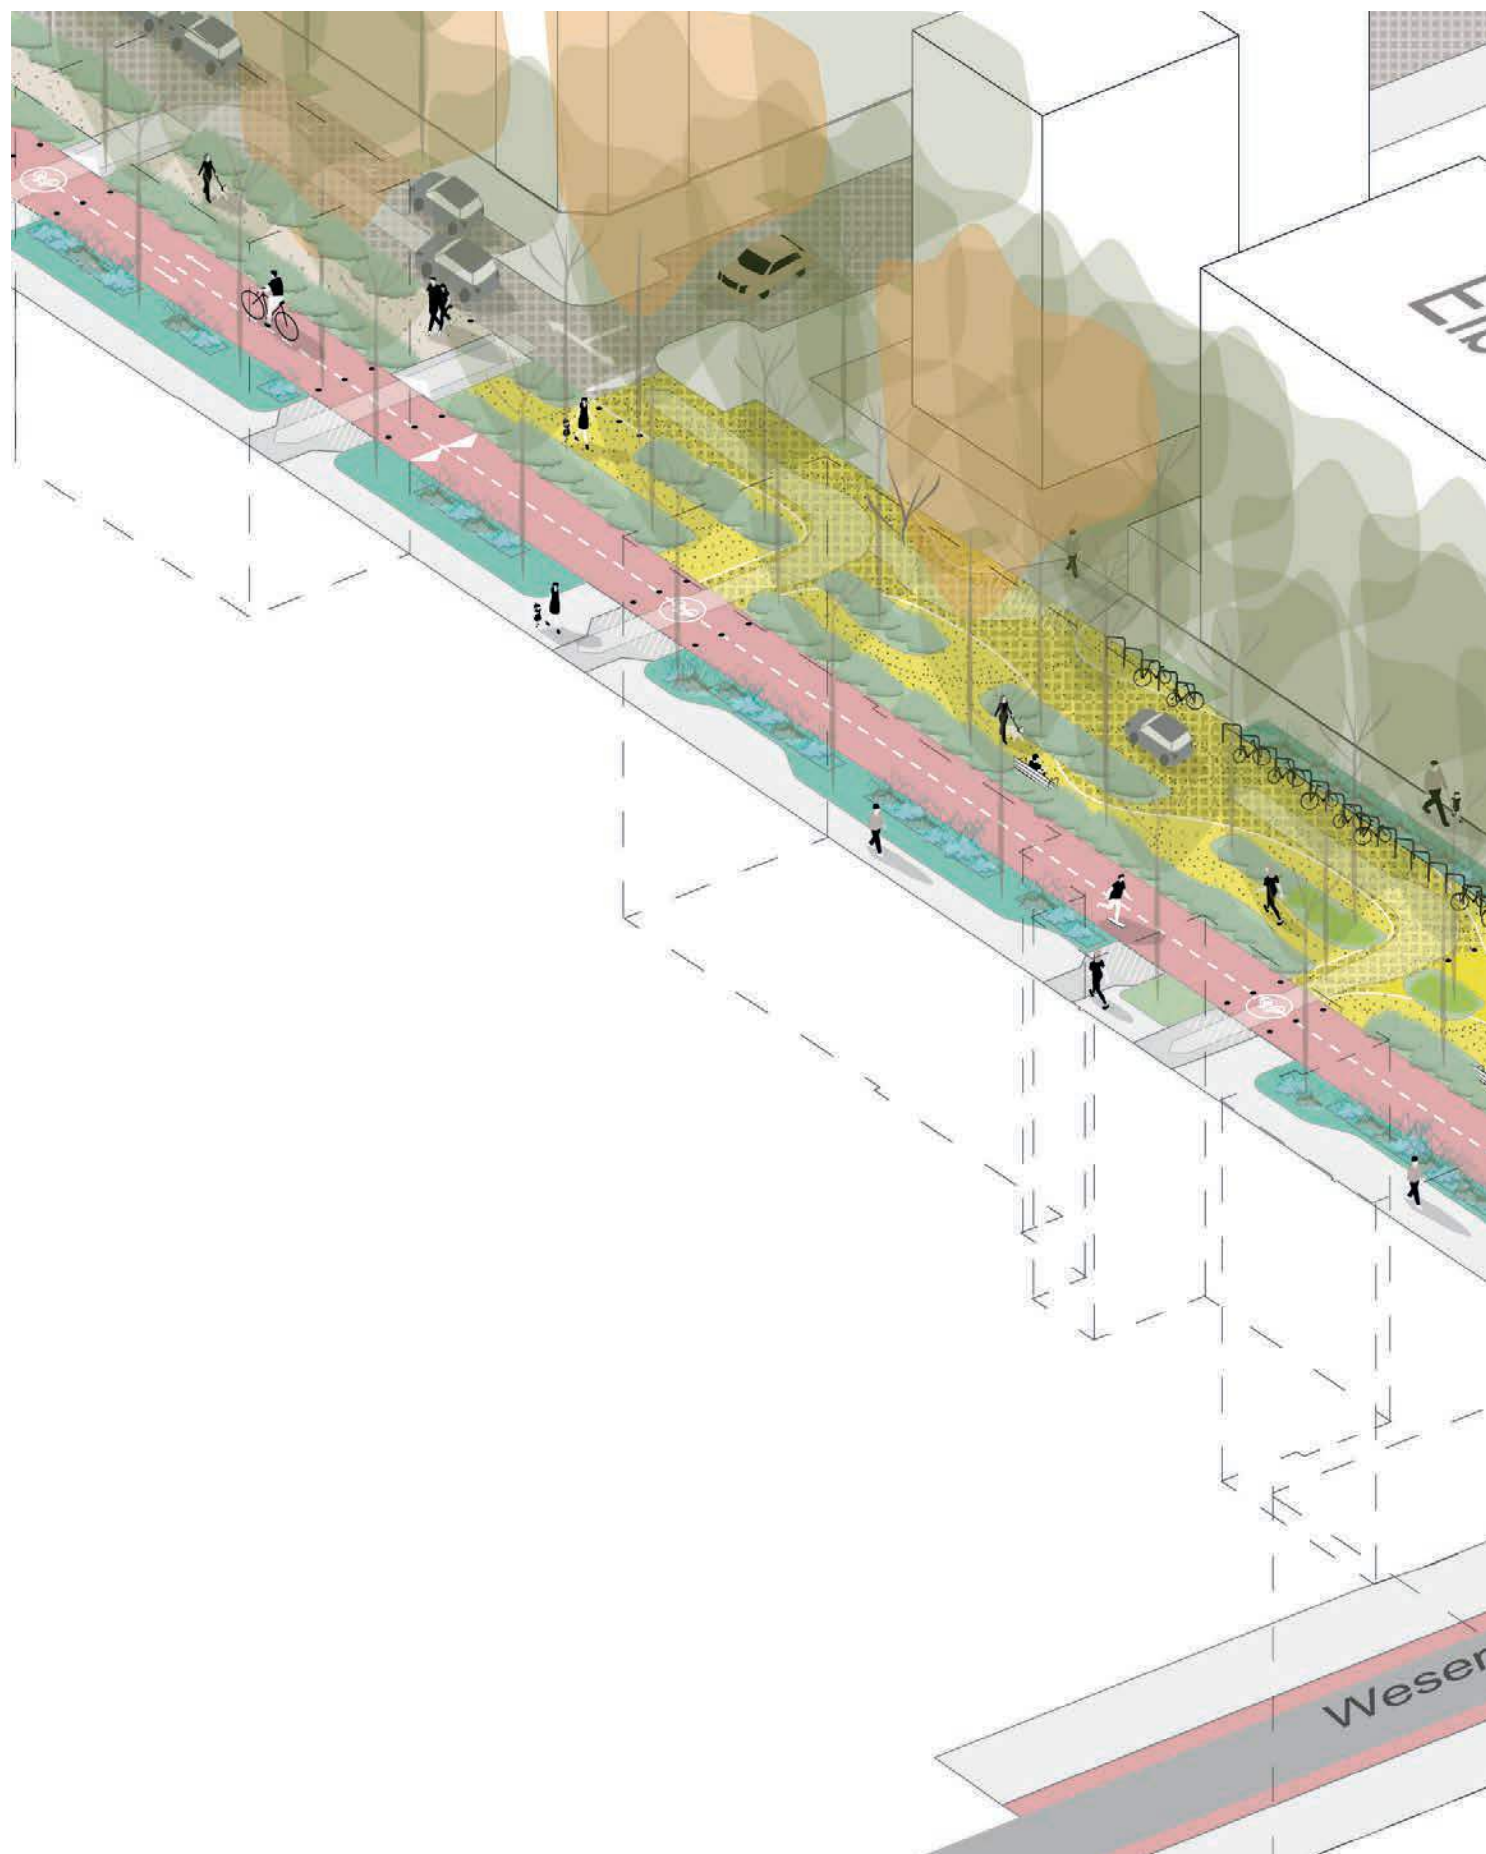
Lageplan Ausschnitt 1:500 Var 5.2 mit kleiner Schul- und Nachbarschaftsfläche
